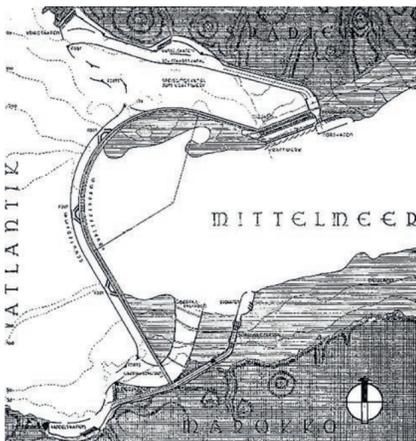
| "PLANTA DA BARRAGEM DE GIBRALTAR"
